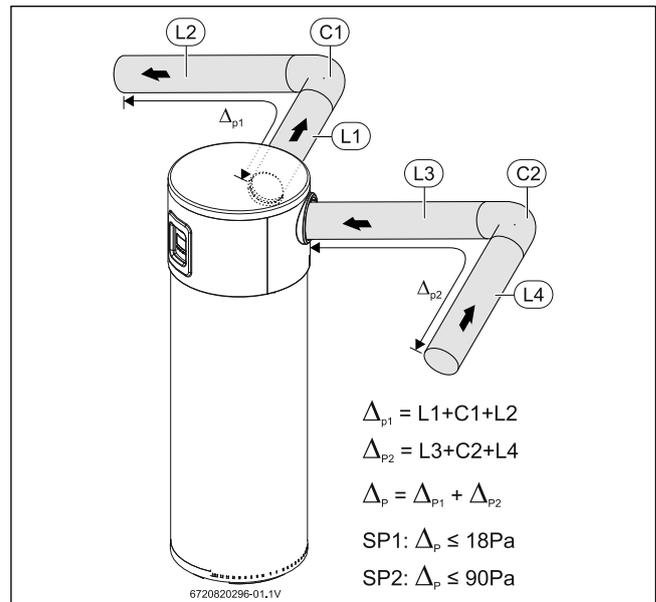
Druckverlust (Pa) für Compress 4000 DW
